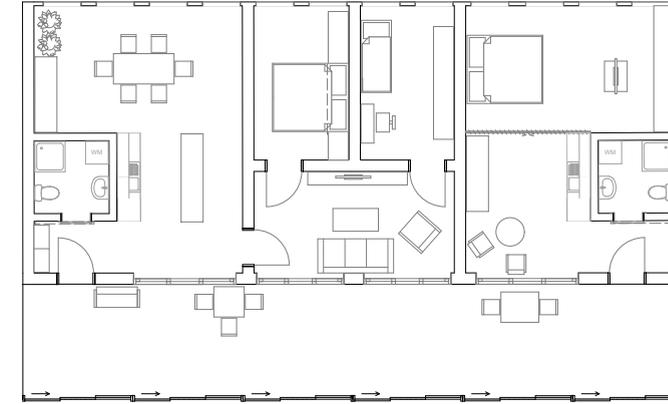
Modifizierbarer Raum Grundrissvarianten
